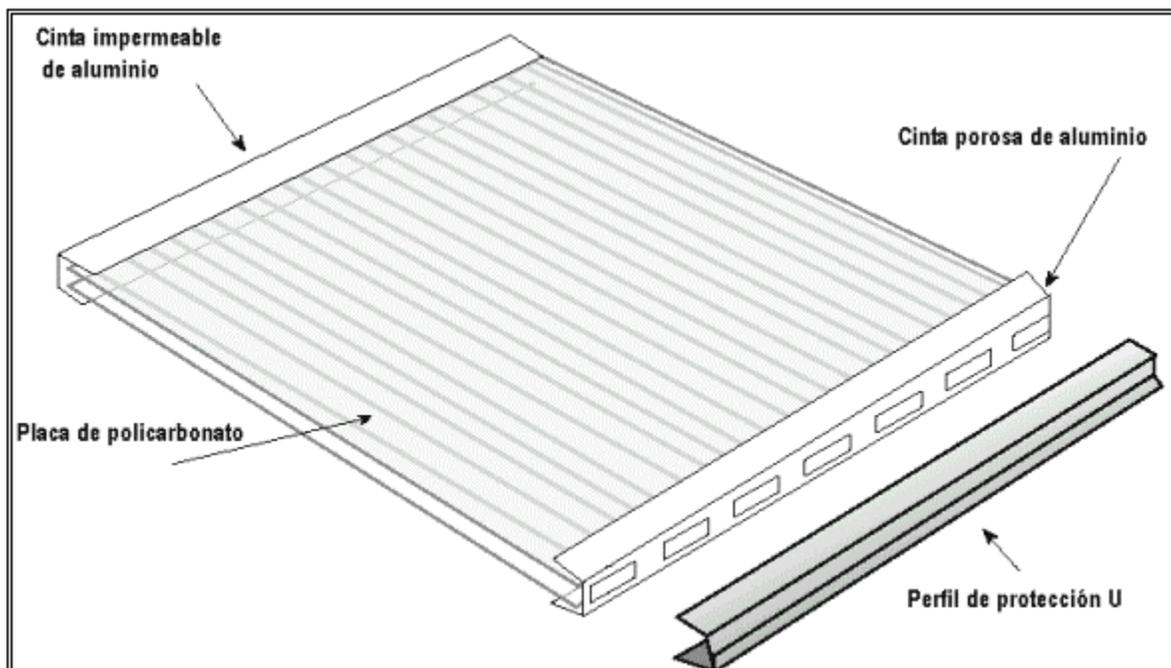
Cintas de aluminio para sellar los alvéolos de las placas.
